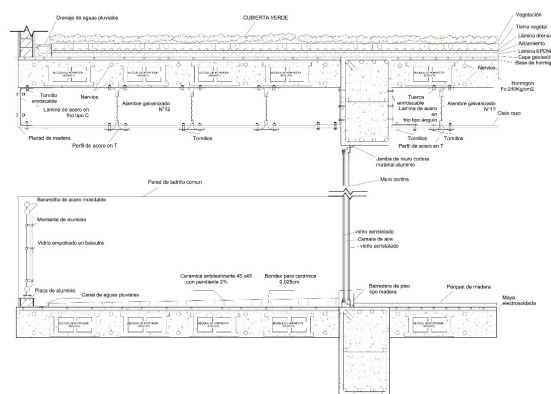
Detalle constructivo del muro cortina, cubierta verde y recolección de aguas pluviales. Fuente: Elaboración propia.
